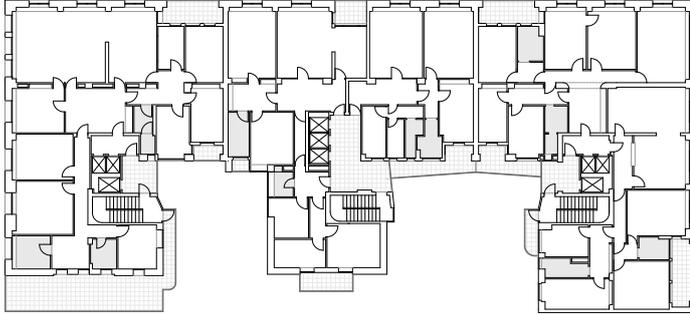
Case Bonaiti Malugani, Grundriss, Piazza della Repubblica 5-7, Giovanni Muzio, 1935-36
